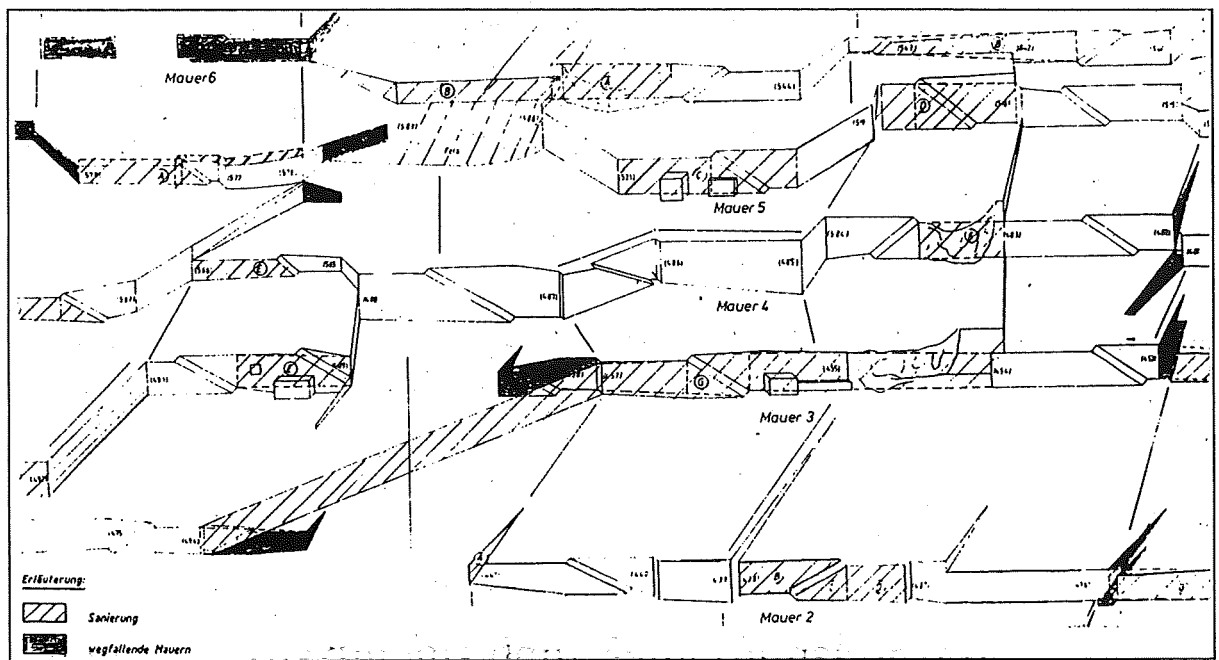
Flächenhafte Sanierung (Auszug aus dem Sanierungskonzept)
